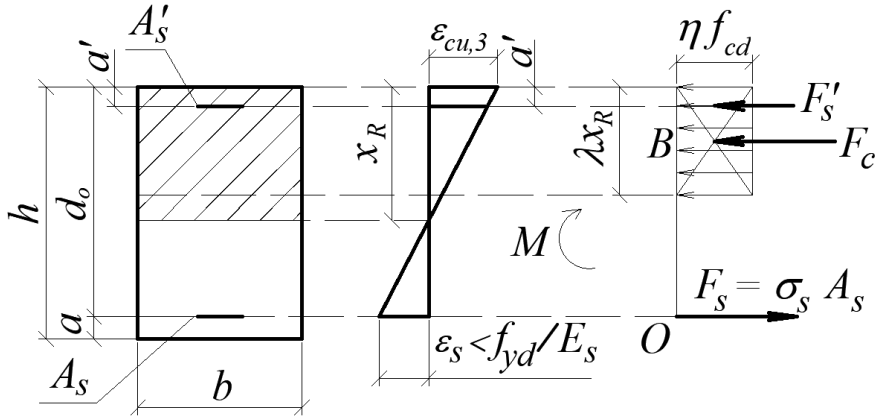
Розподіл деформацій, напружень та зусиль у нормальному перерізі з подвійним армуванням
